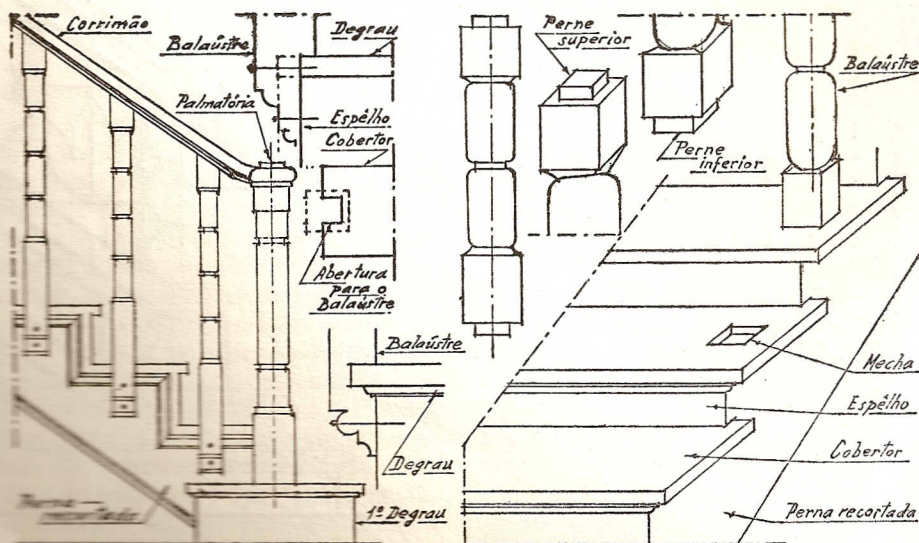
BALAUSTRADA DE MADEIRA NAS ESCADAS À INGLESA
